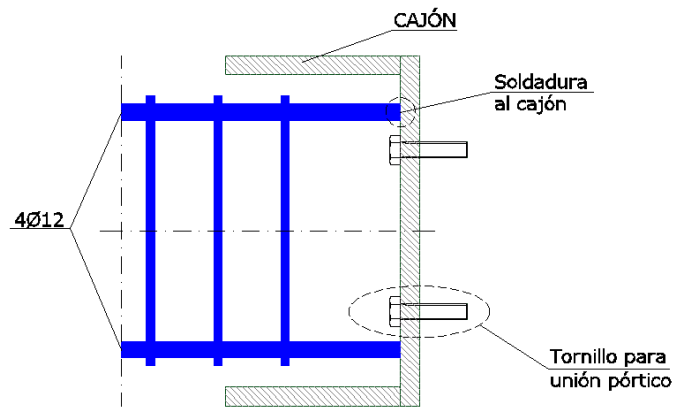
Detalle de la soldadura de la armadura longitudinal del soporte al cajón metálico del extremo
